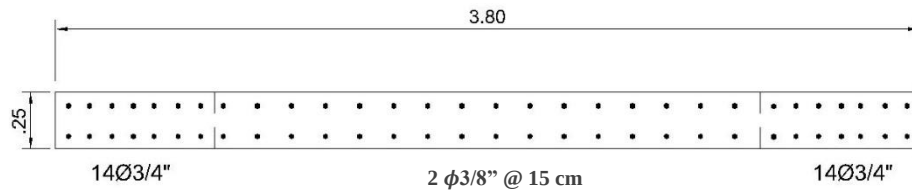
Armado preliminar por flexión y carga axial para el muro estructural del ejemplo.
